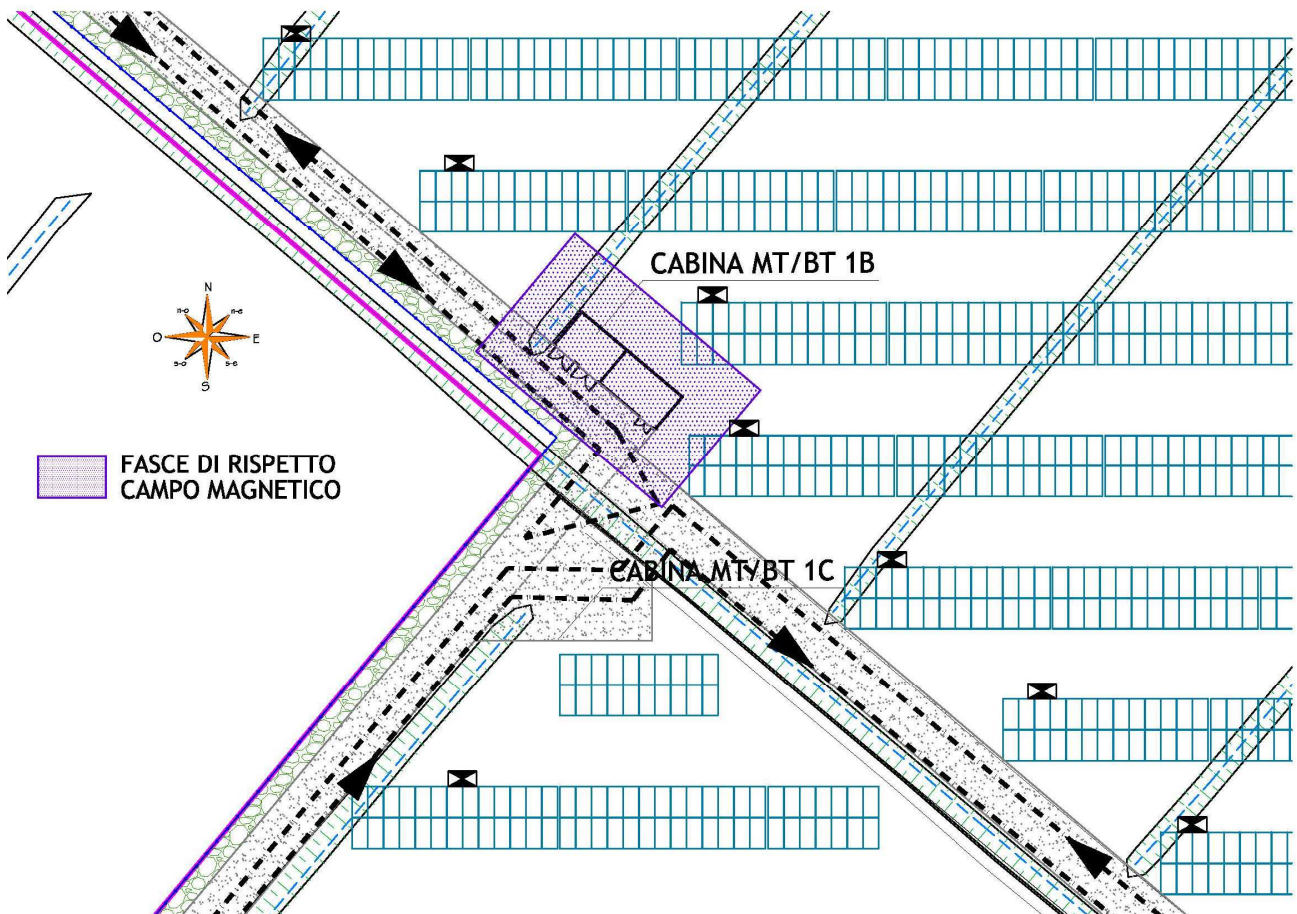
Planimetria individuazione fasce di rispetto determinate
